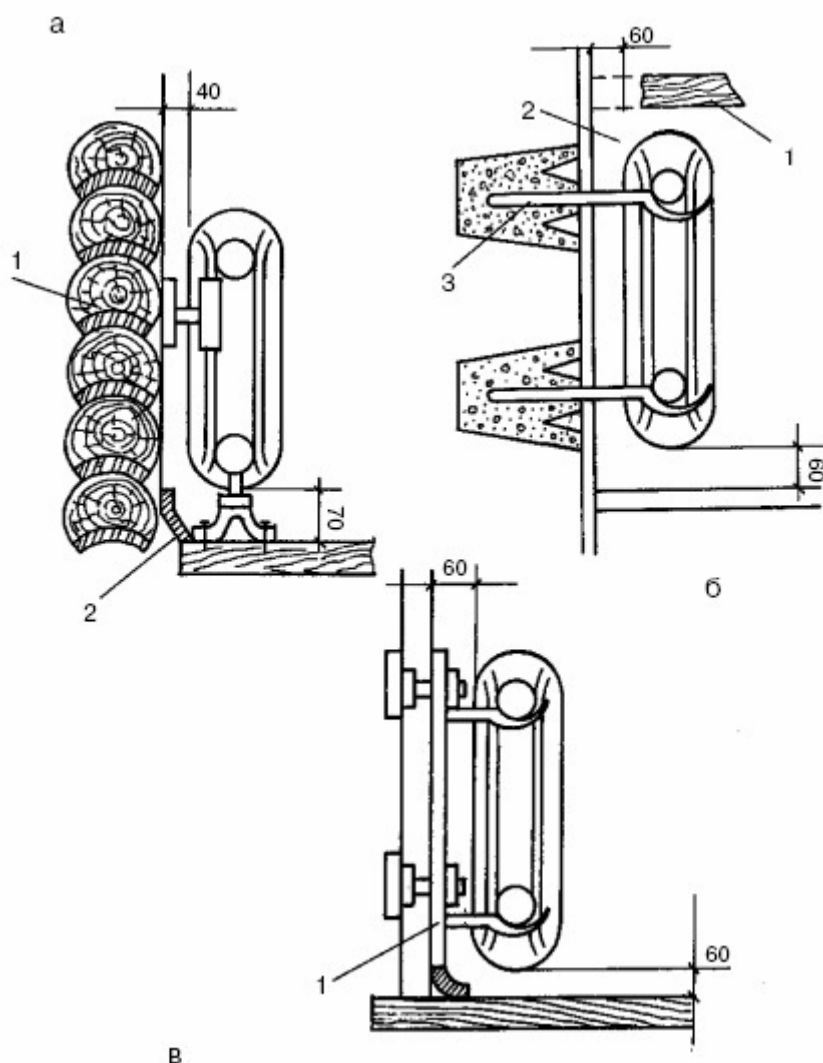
Монтаж чугунных радиаторов: а – у деревянной стены: 1 – планка; 2 – подставка; б – у кирпичной оштукатуренной стены: 1 – подоконник; 2 – ниша; 3 – кронштейн; в – у стены облегченной конструкции: 1 – кронштейн с цельной опорой
